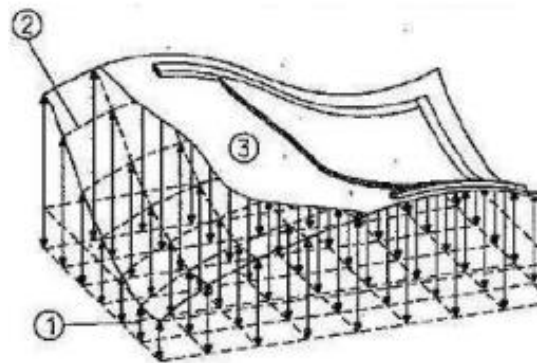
Diseño de molde flexible de Florian-Peter Kosche.
